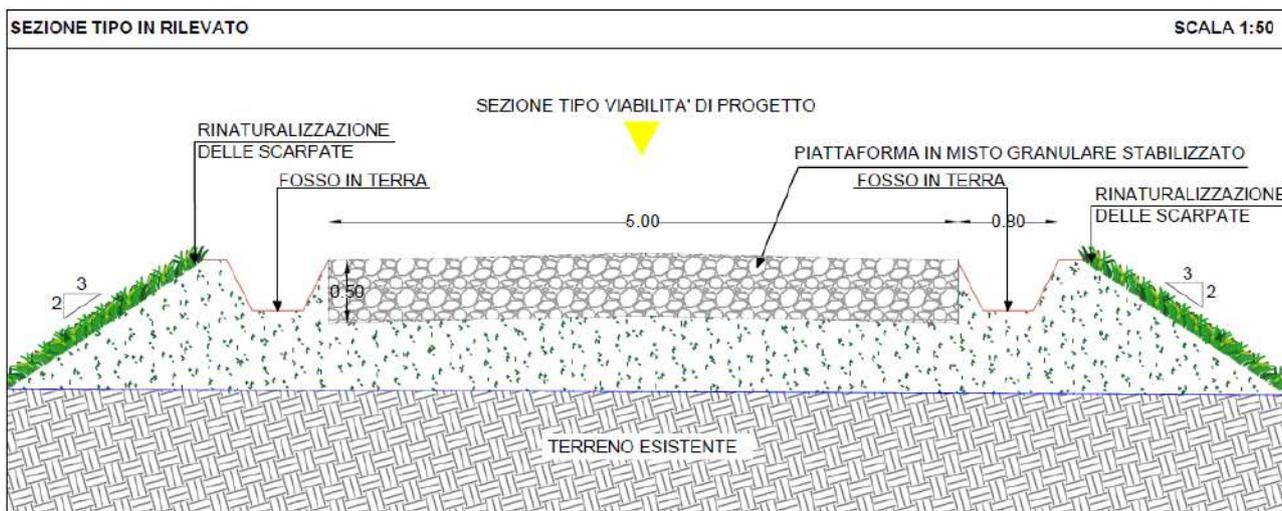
Sezione tipo in rilevato per la nuova viabilità
